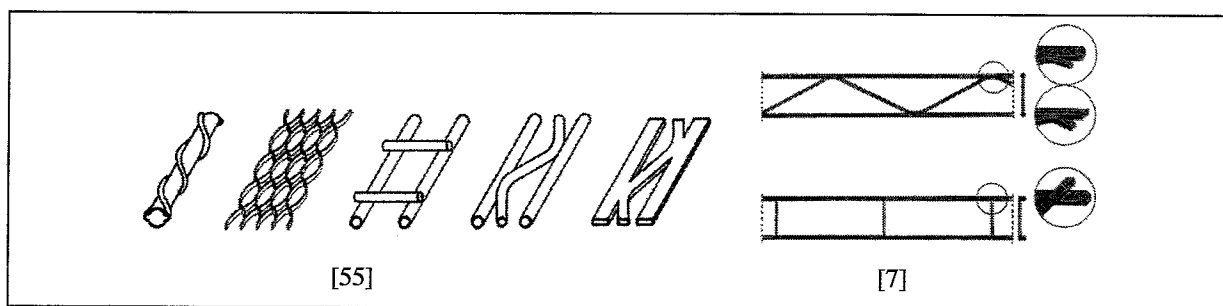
Tipos de armaduras para juntas horizontais de alvenarias
